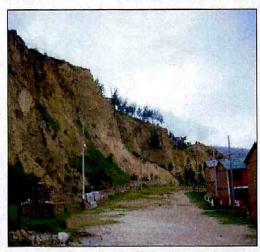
Anden de la Carrera 72 entre las Calles 68A Sur y 68B Sur
